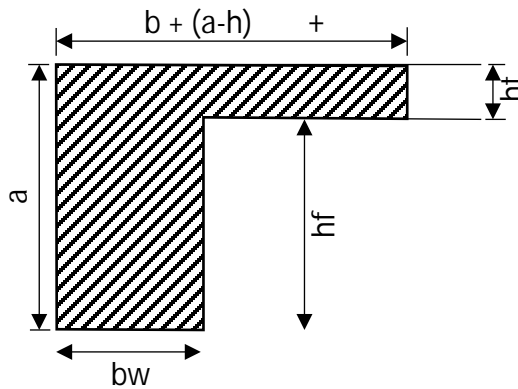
Sección de viga externa y losa a incluirse en diseño a torsión
